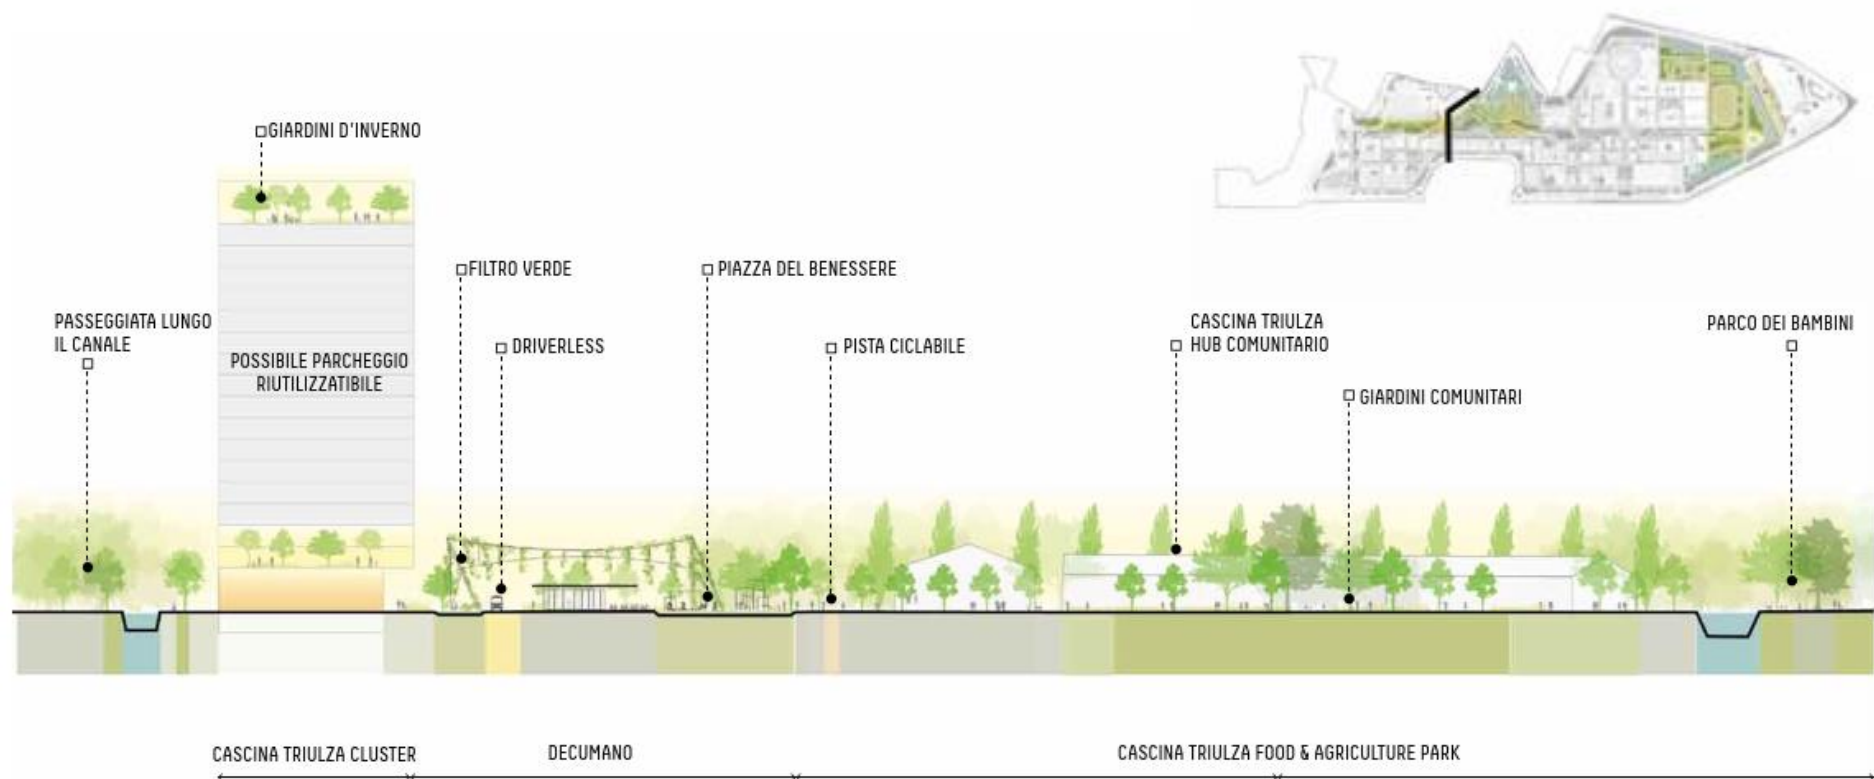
Piazza del Benessere – sezione paesaggistica tipo
